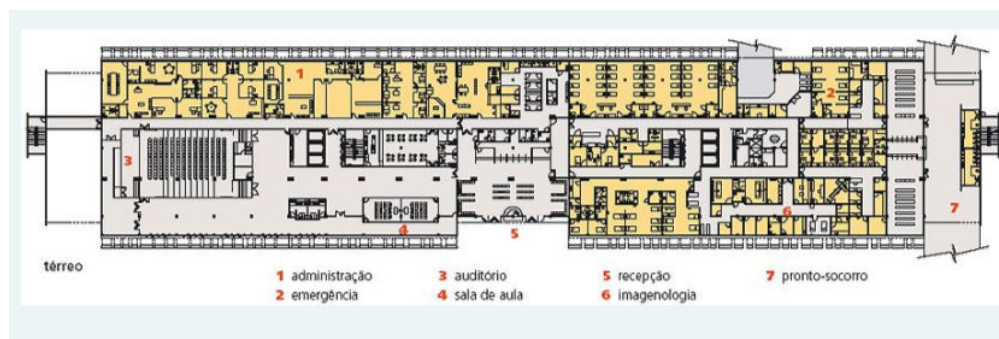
Planta baixa - térreo (FIGUEROLA, 2007).
